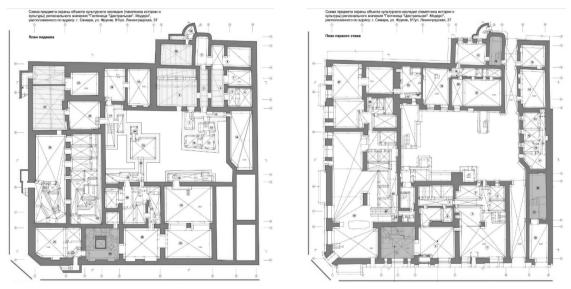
План подвала и первого этажа с обозначением предмета охраны: фасадов, несущих конструкций стен, лестниц и сводов Монье
